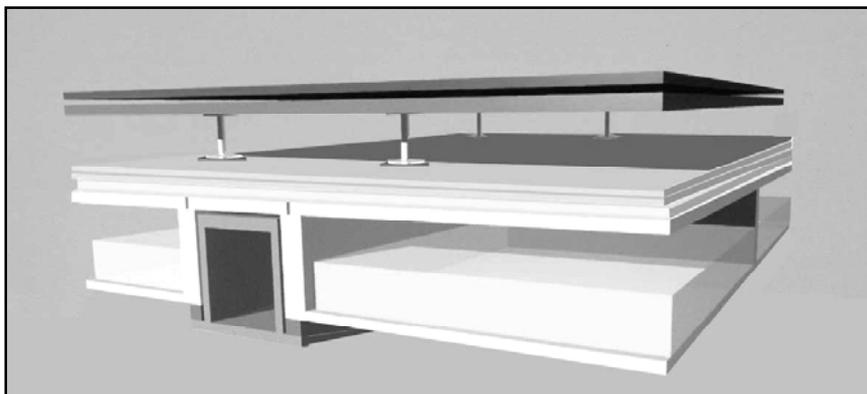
Deckenaufbau mit schwimmenden Trockenestrich
